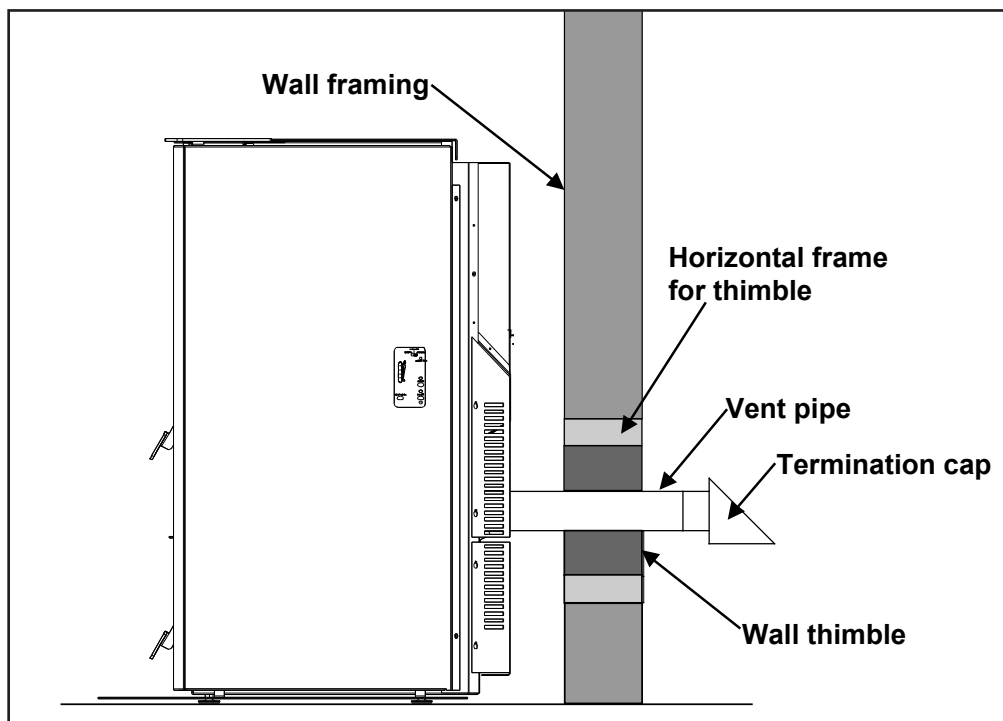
Tout Droit à Travers L'Installation de Mur - Vue de Côté.
